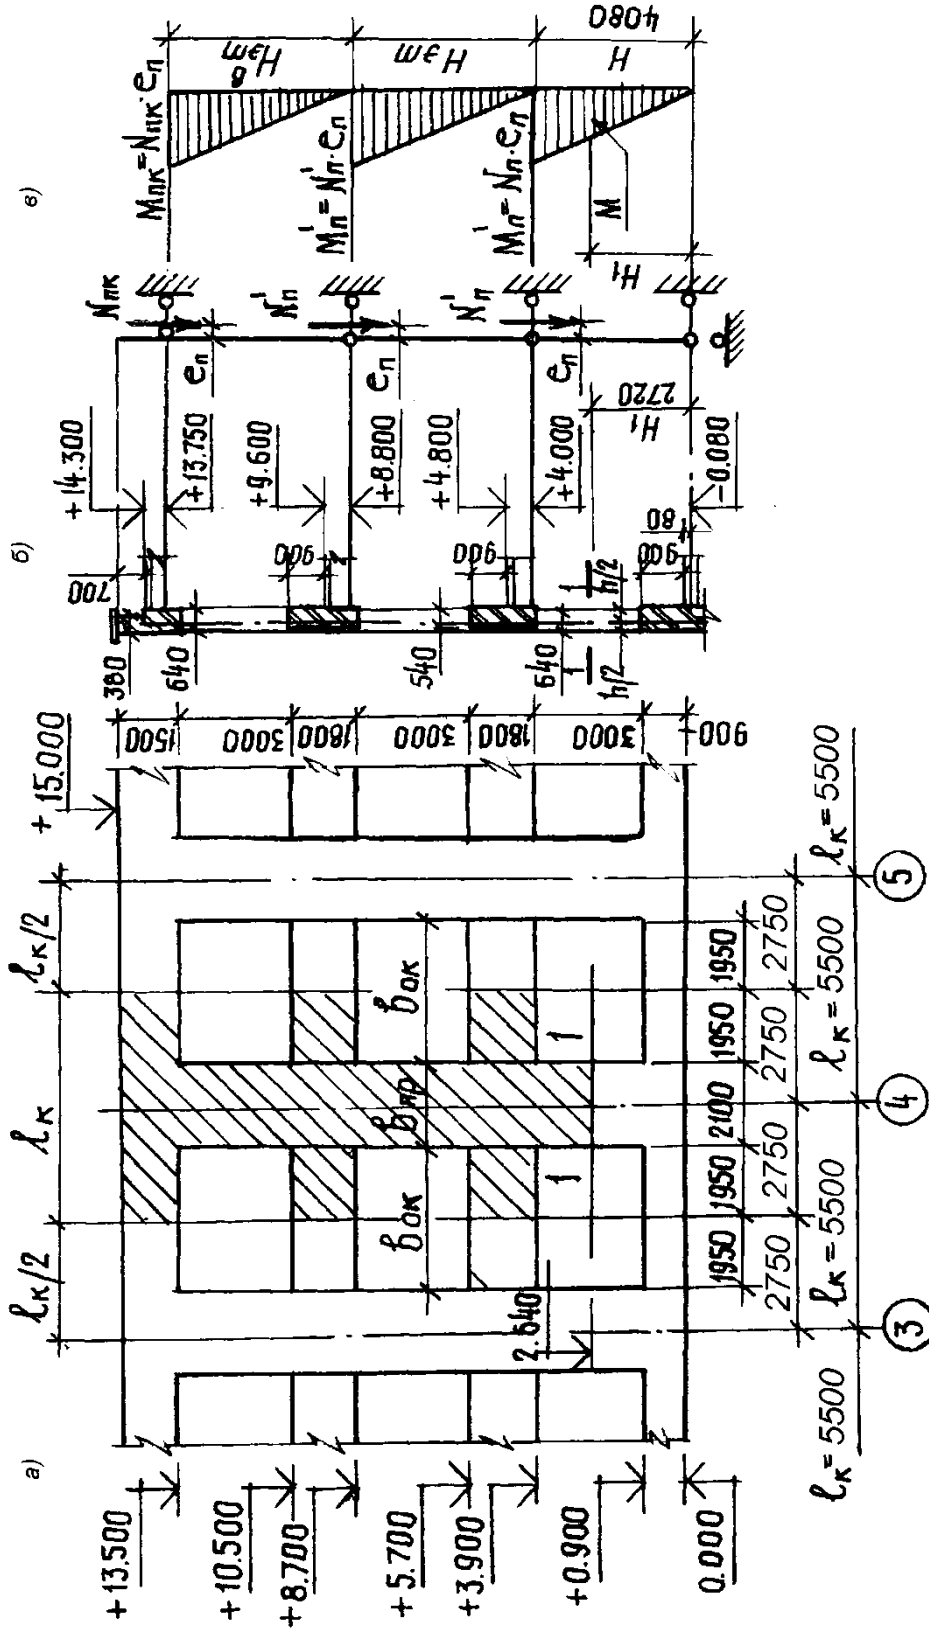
К примеру 1: а) фрагмент фасада, б) разрез по наружной стене, в) эпюра моментов
